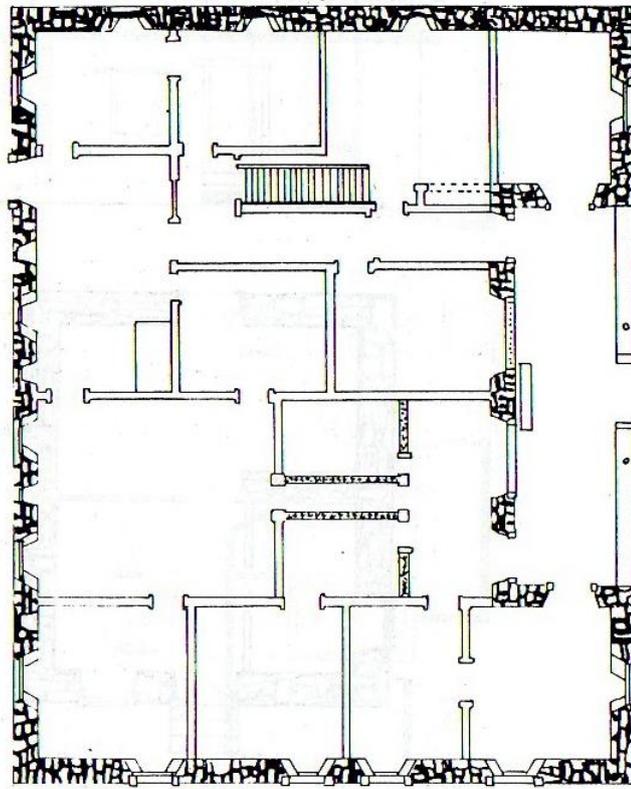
Planta baixa da Fazenda do Manso, em Ouro Preto, importante exemplar de *casa de arrebalde*.
